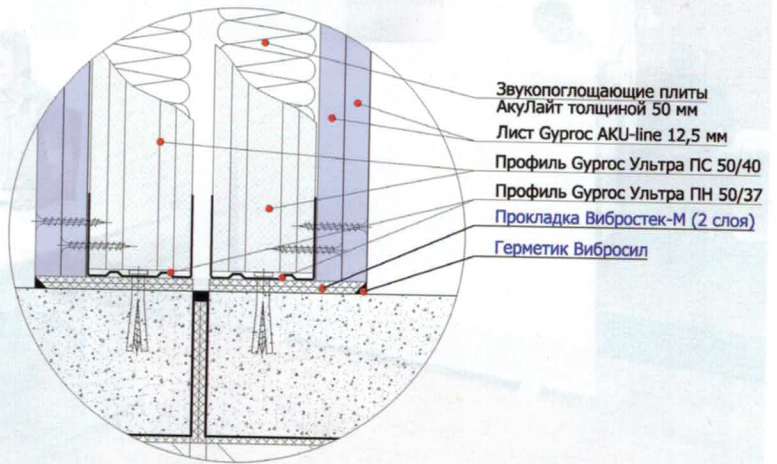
Узел примыкания звукоизолирующей конструкции к перекрытию
